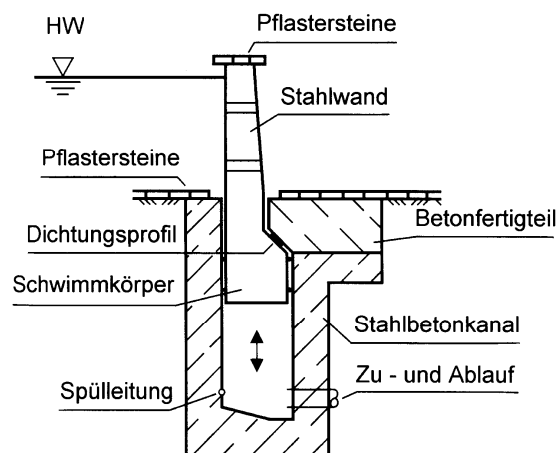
Bewegliche HW-Schutzkonstruktion - Versenkbare Wand [Patt]
